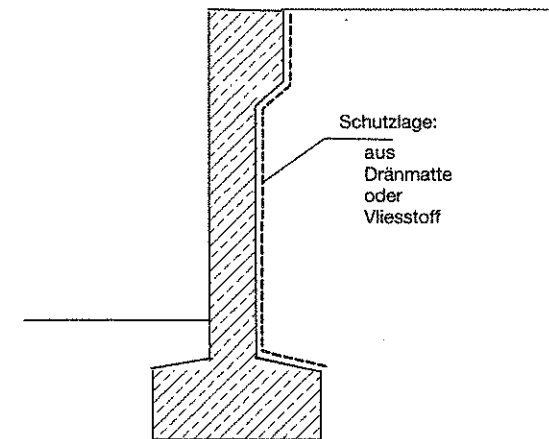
Geotextil zum Schutz des Dichtungsaufstriches – kann mit dem Zweck der Bauwerksdränung (Bild 23) kombiniert werden
